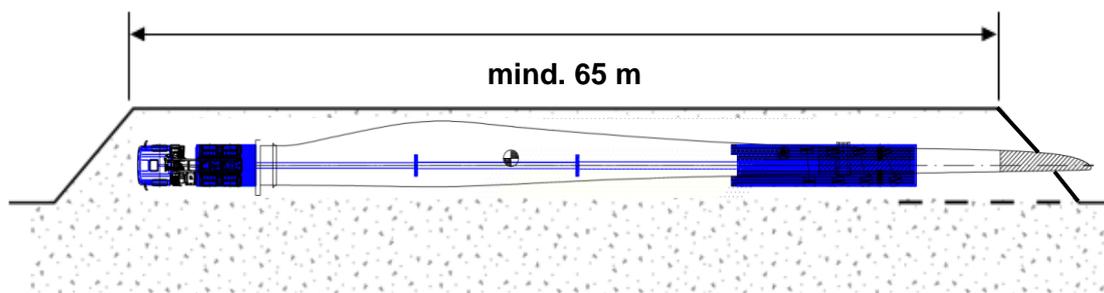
Beispiel Ausweichfläche für Transportfahrzeug mit 61,6 m Rotorblatt
